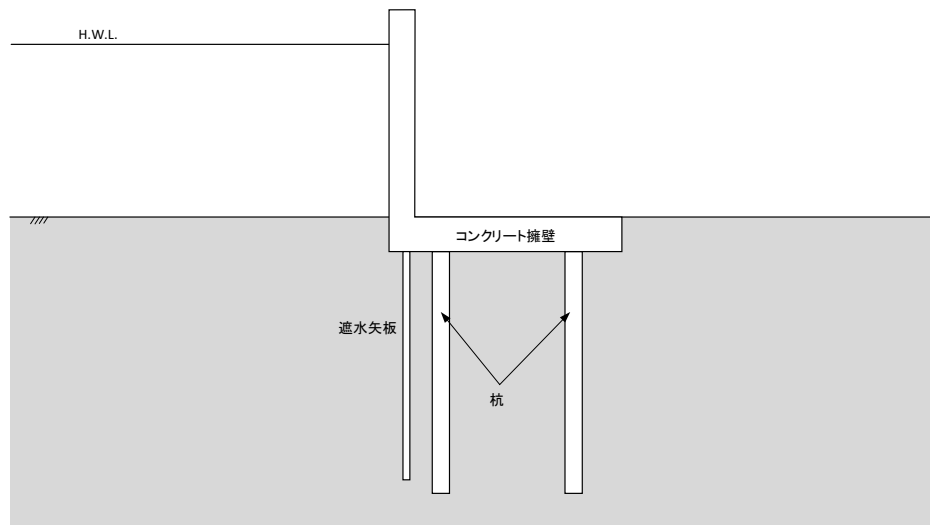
コンクリート擁壁の代表的な構造 (L 型杭基礎形式)
